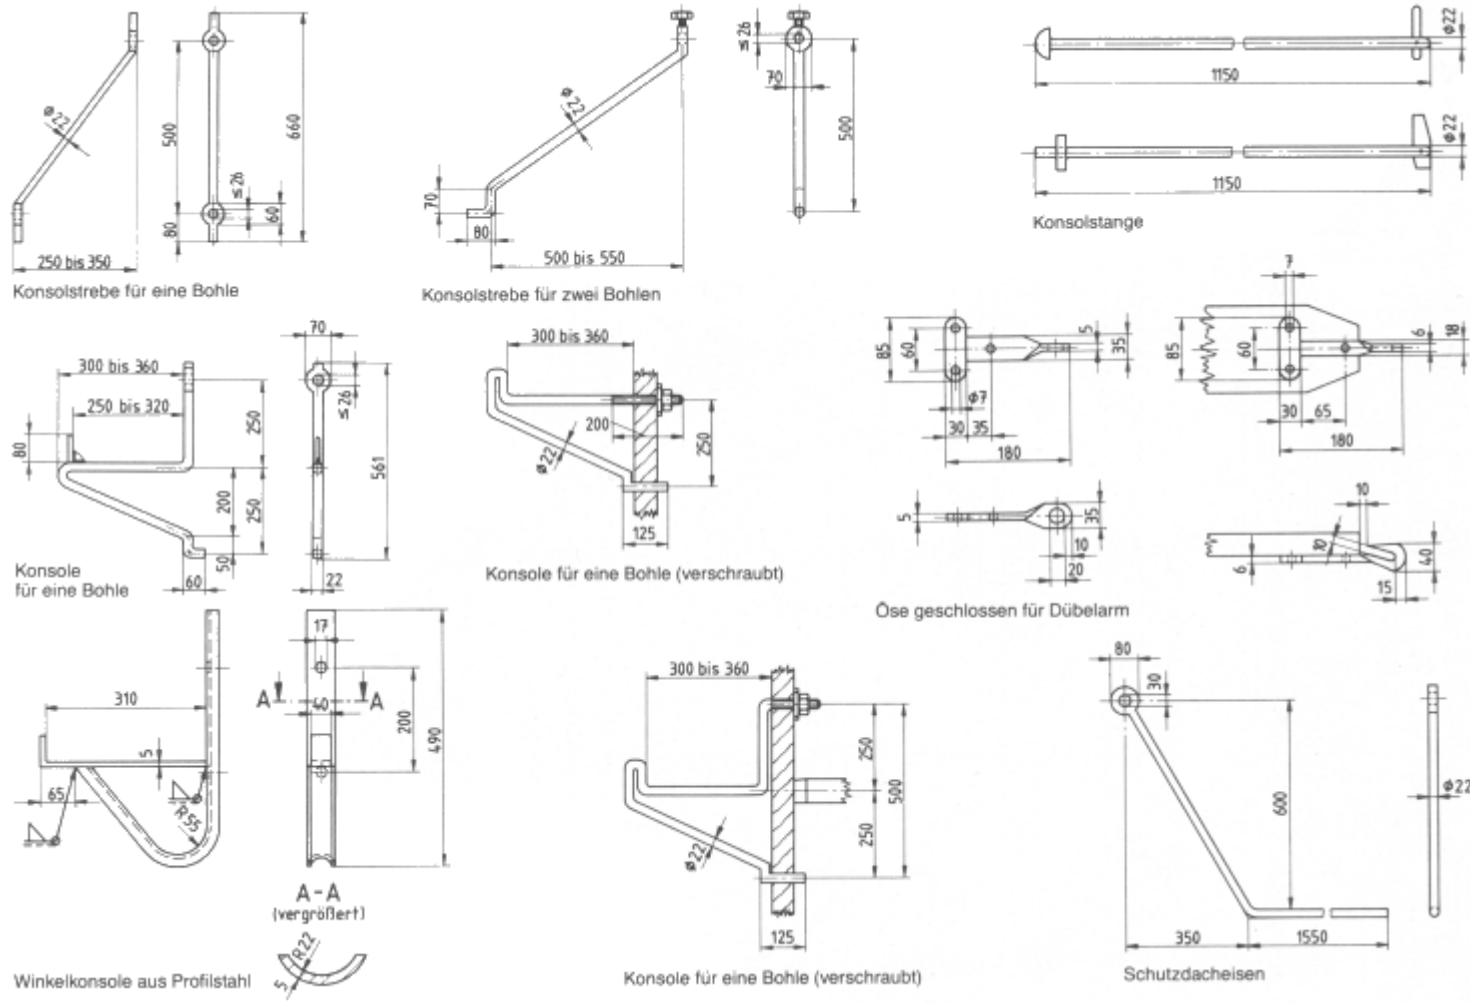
Formen, Maße und Ausführungen von Leitergerüstbauteilen aus Stahl (Maße in mm)
